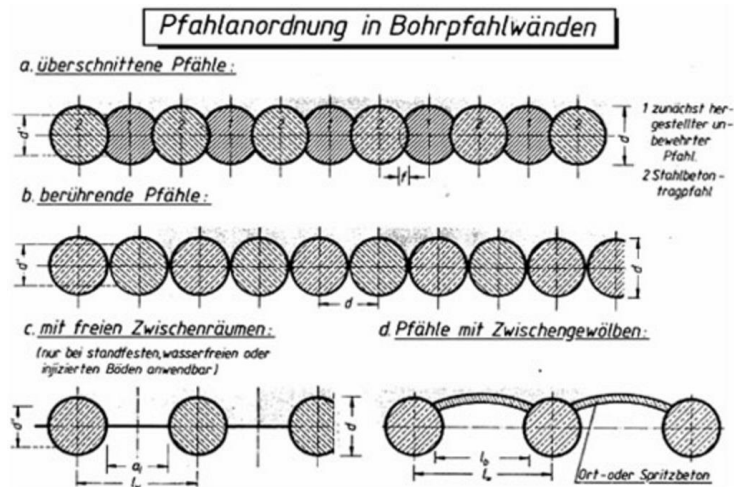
Grundrisse von Bohrpfahlwänden⁴⁰
